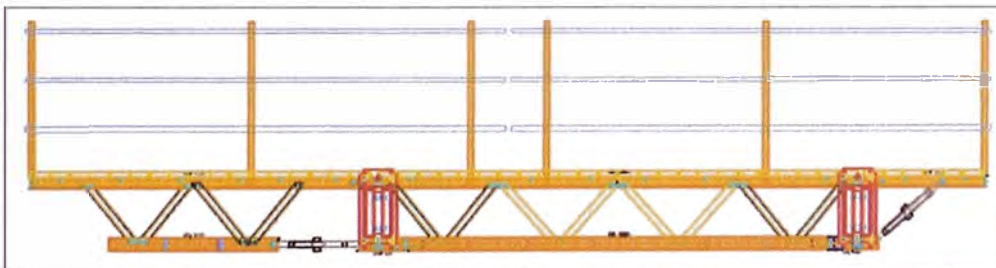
Vista elevación de celosías con riostras MK-120.
